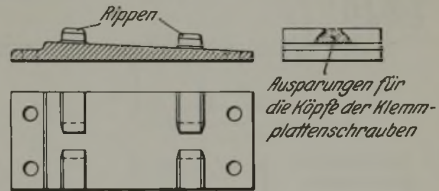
Längsschnitt, Grundriß und Seiten- ansicht der Rippenplatte für Holzschwellen.
